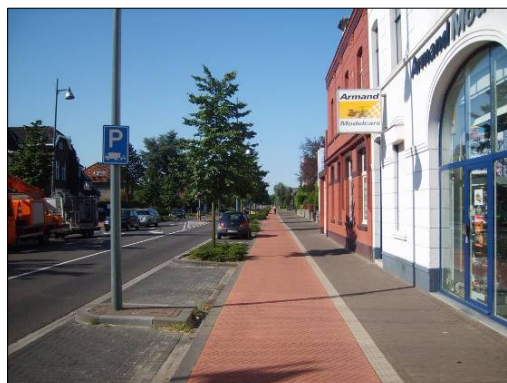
Vrijliggende fietspaden langs de Rijksweg boulevard
